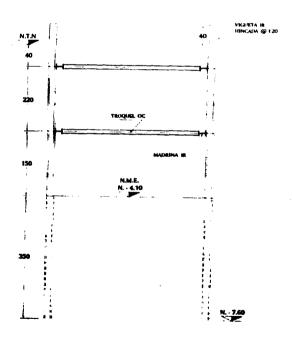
34 DETALLE DE HINCADO DE VIGUETAS SECCION A - A
